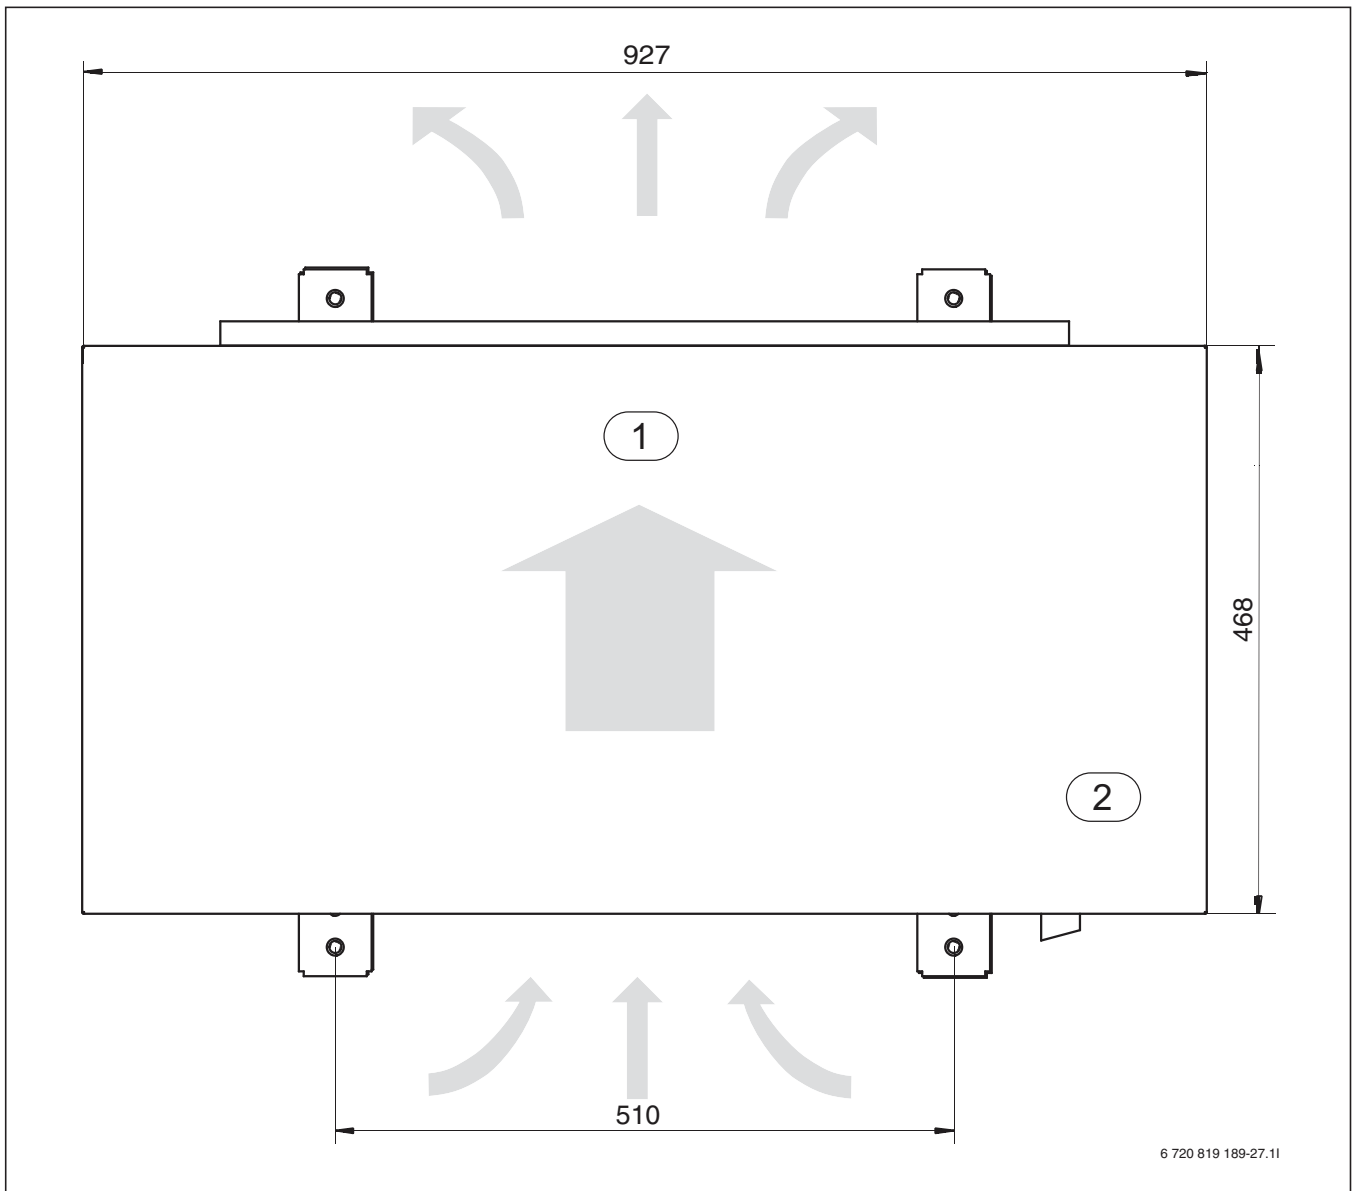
Abmessungen IDUWP6 und IDUWP8, Draufsicht (Maße in mm)
